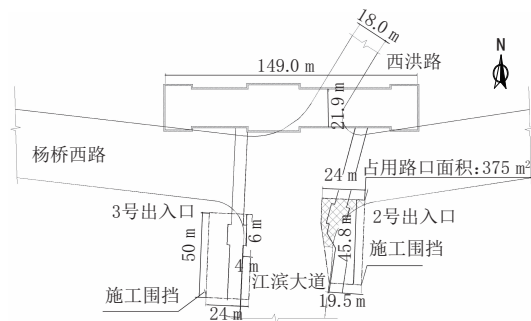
金牛山站2号、3号出入口过街通道顶管施工占地平面图
